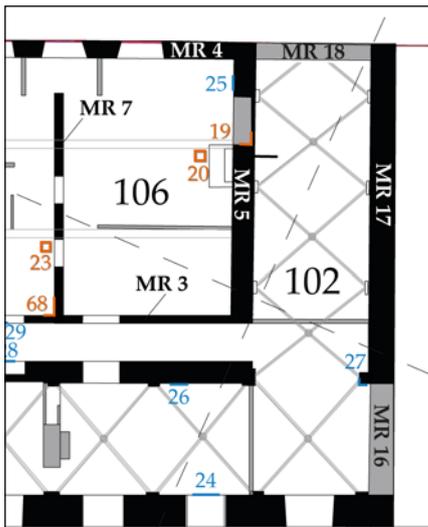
Plan de localisation des faits de l'espace 102 (DAO M. Panneau, S. Ranchin)
